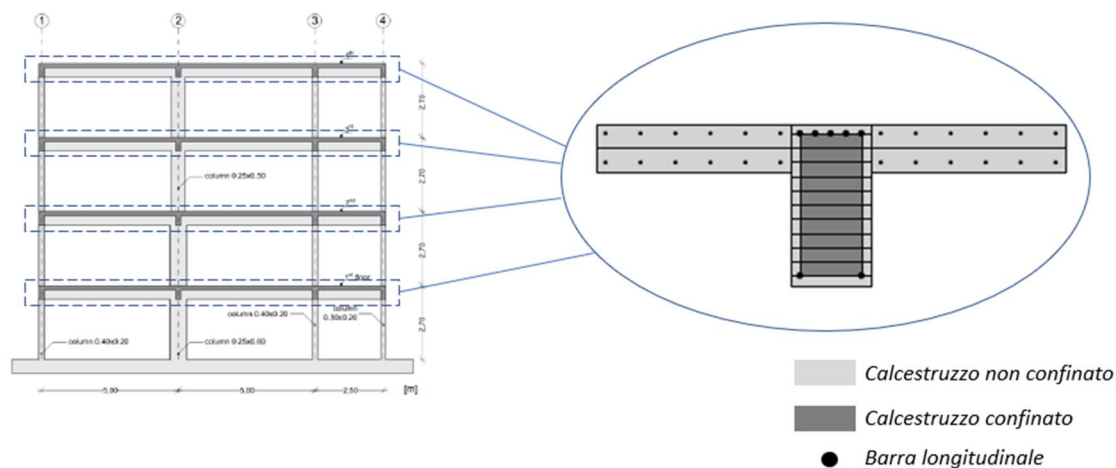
Modellazione a fibre della sezione trasversale del piano tipo [40].
